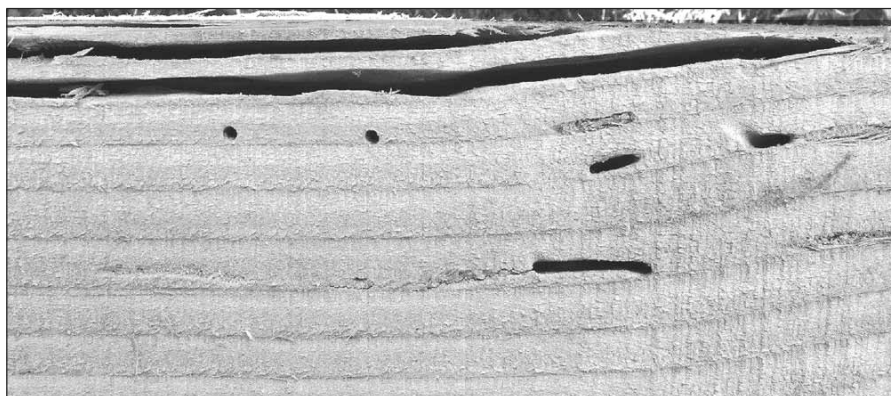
Galerías excavadas en el leño temprano en la viga de pino oregón.
